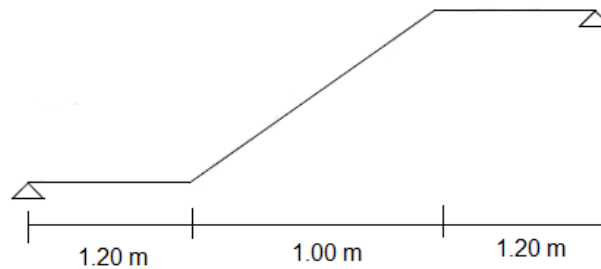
Elevación Segundo Tramo Escalera del Piso Típico
